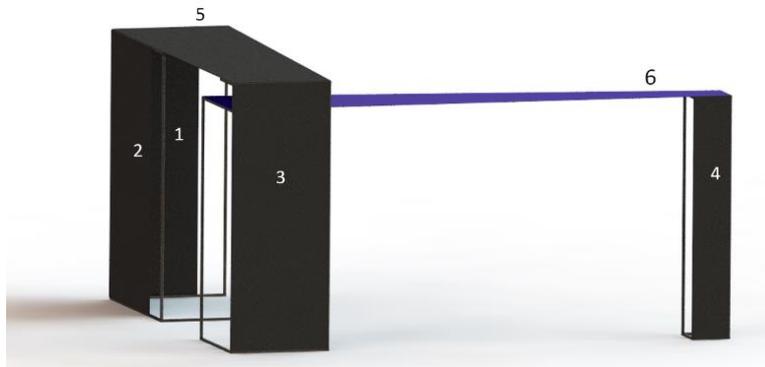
Detalles planchas/paneles PE StacBond instalados en los módulos cubos.
